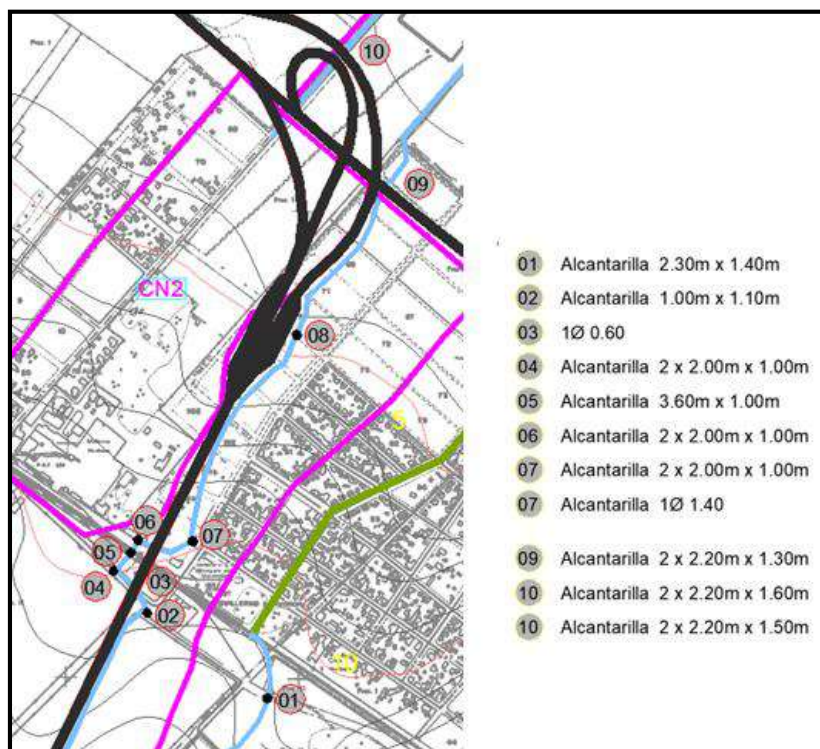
Ubicación y detalle de alcantarillas relevadas.
